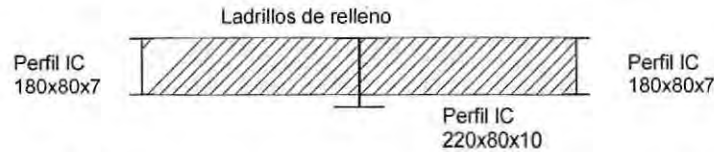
Corte 2-2 planos de elevación Figura 1.12, configuración 2° piso.
